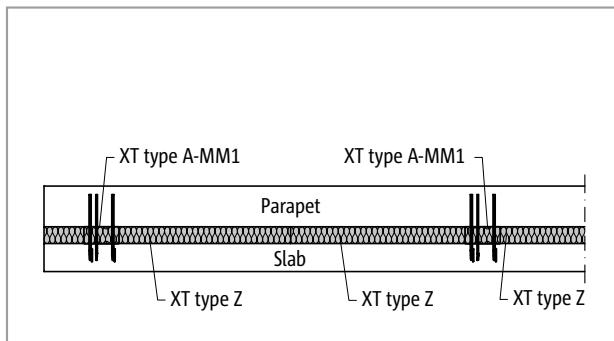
Schöck Isokorb® XT type A, Z: Attic (XT type A-MM1)
